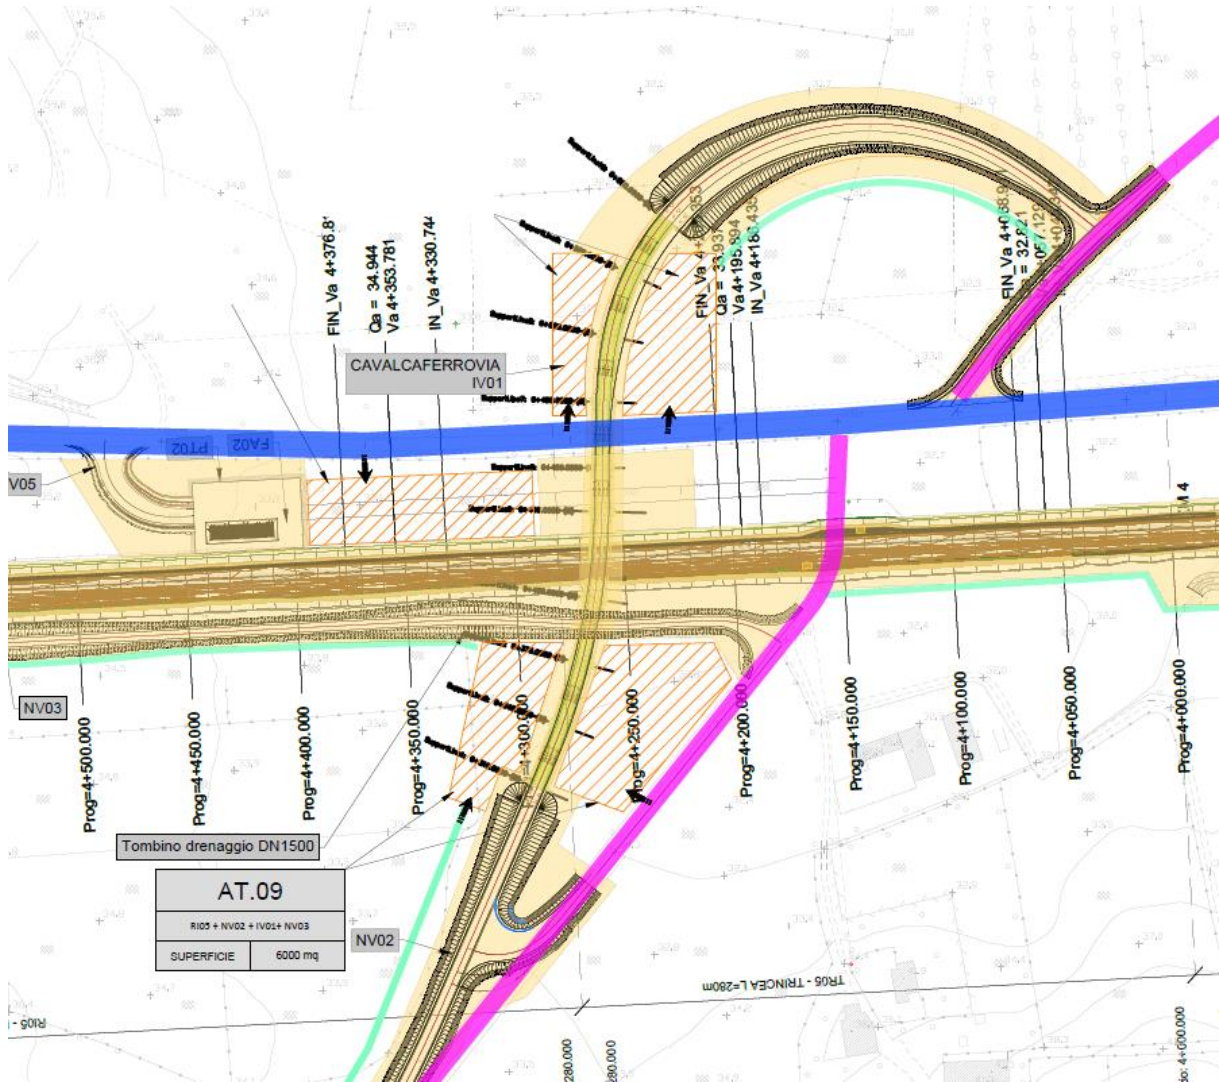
Vista in pianta dell'area di cantiere AT.09
